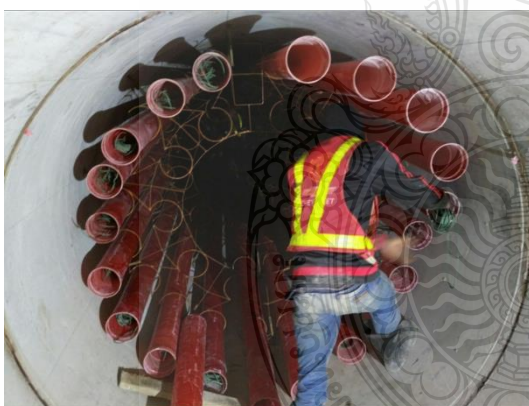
เครื่องดันท่อลอด (Pipe Jacking Machine) [ฤทธิ์ชัย]
